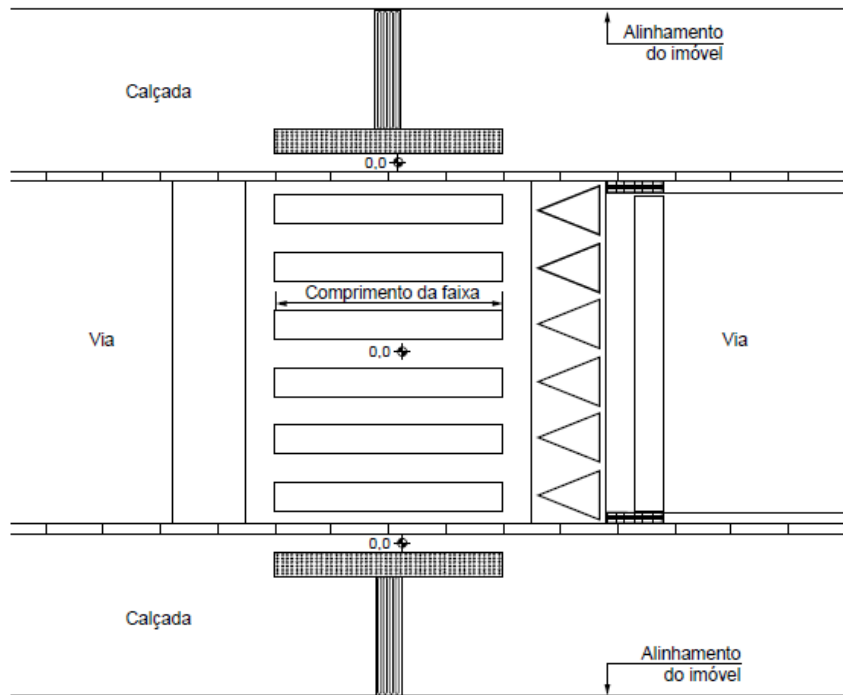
Faixa elevada para travessia - Exemplo - Vista superior
